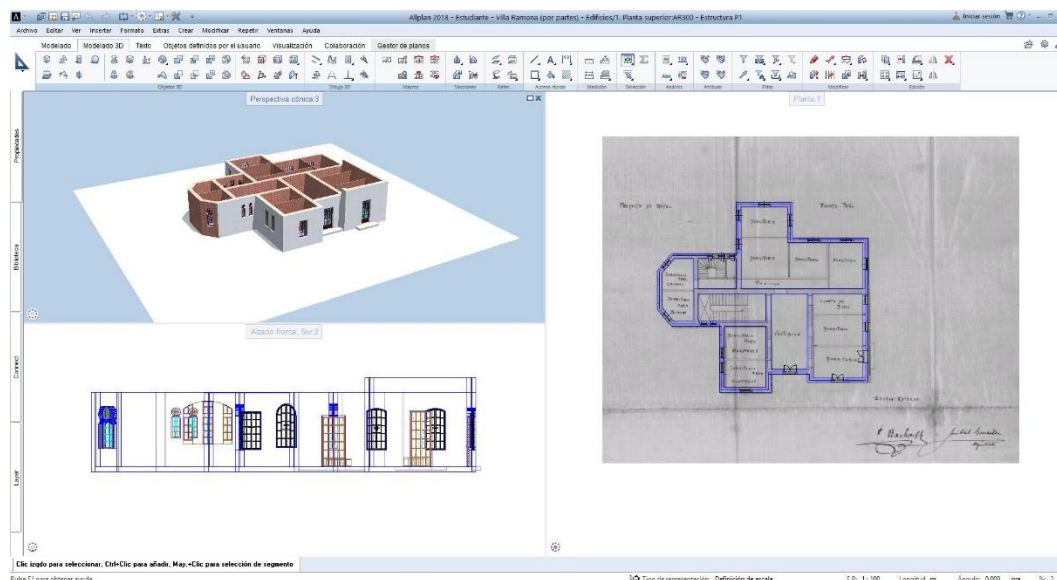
Generación planta primera. Elementos constructivos generales Allplan 2018. Fuente: Elaboración propia
